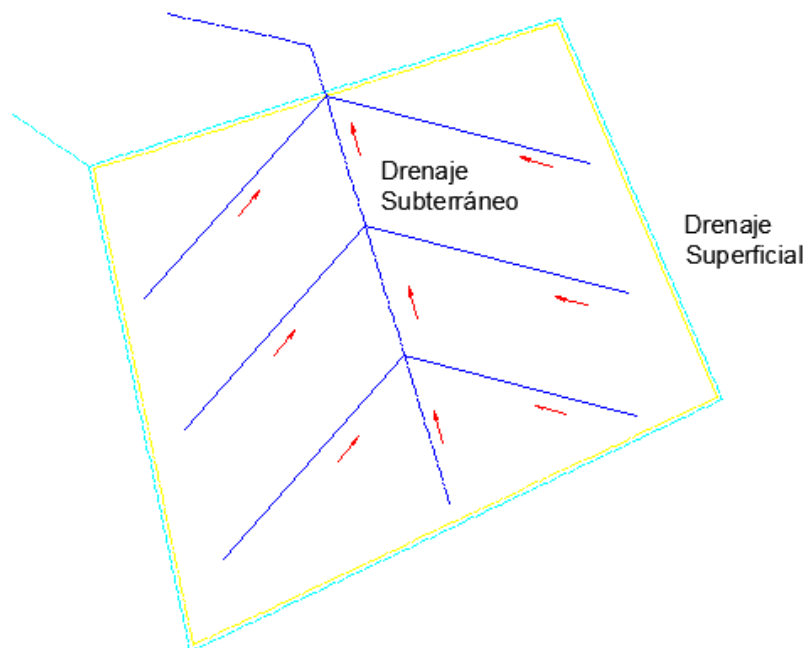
Vista en planta Drenaje superficial y subterráneo
